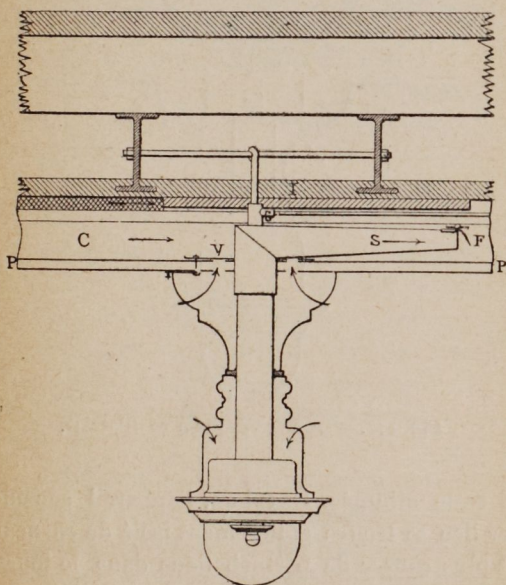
Lampe à gaz ventilatrice installée dans un plafond.
